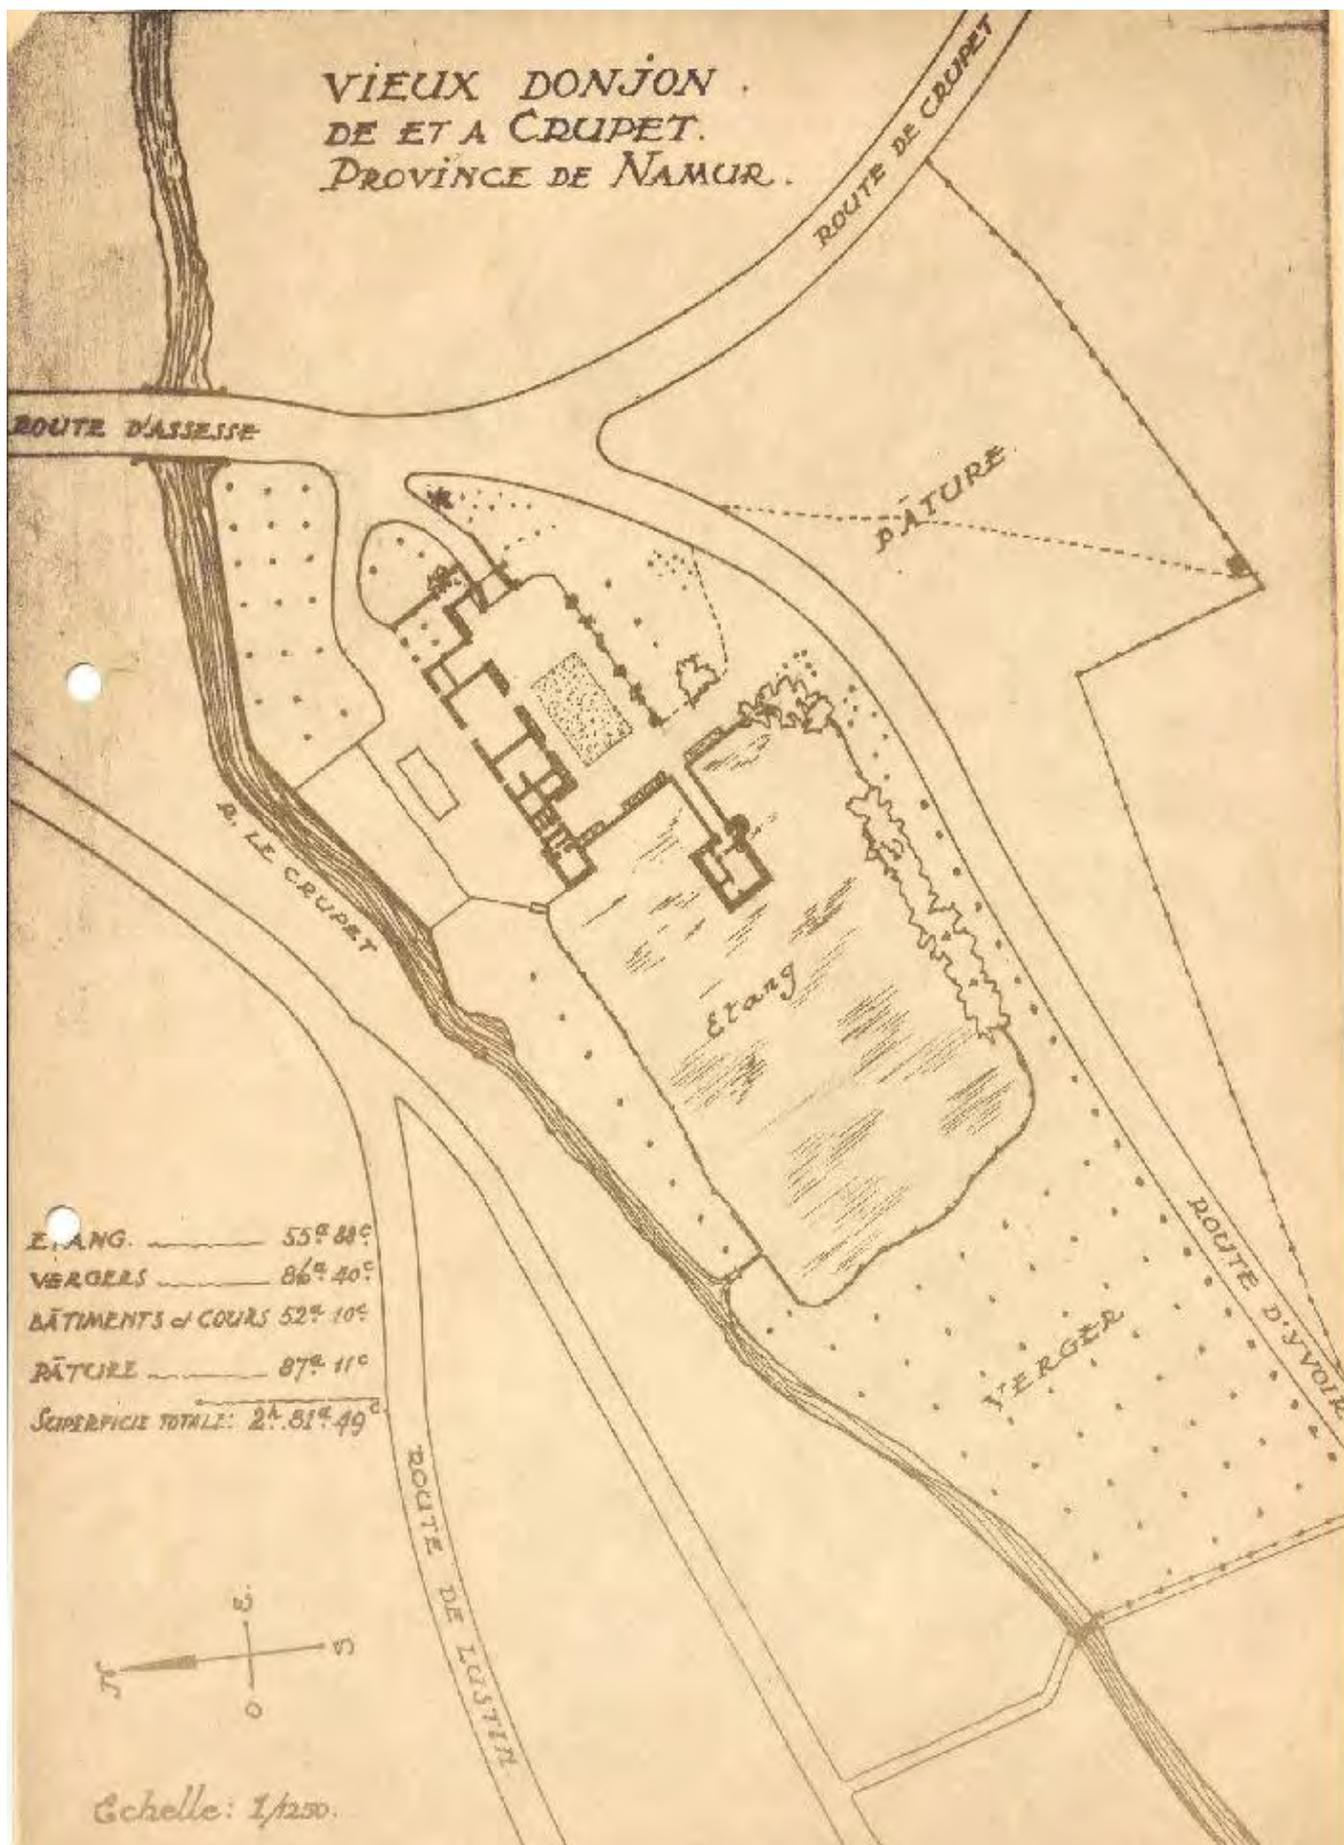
et 2. Plans d'Adrien BLOMME pour la restauration du château de Crupet en 1925.
